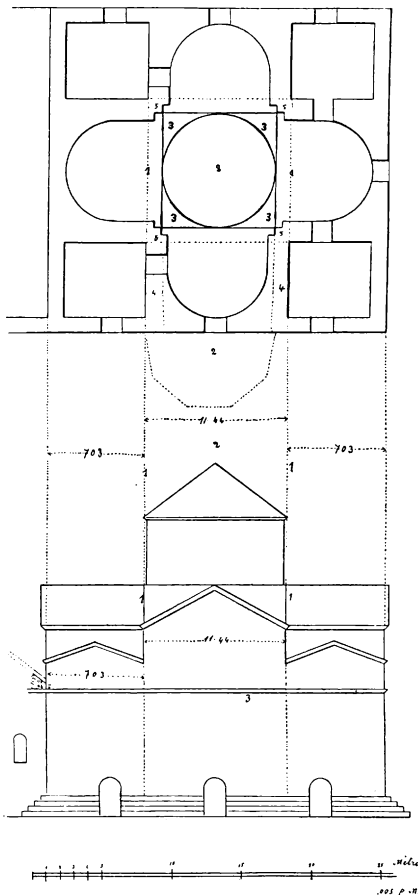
Рис. IV. Первоначальный планъ и фасадъ Эчміадзина съ сѣвера.
